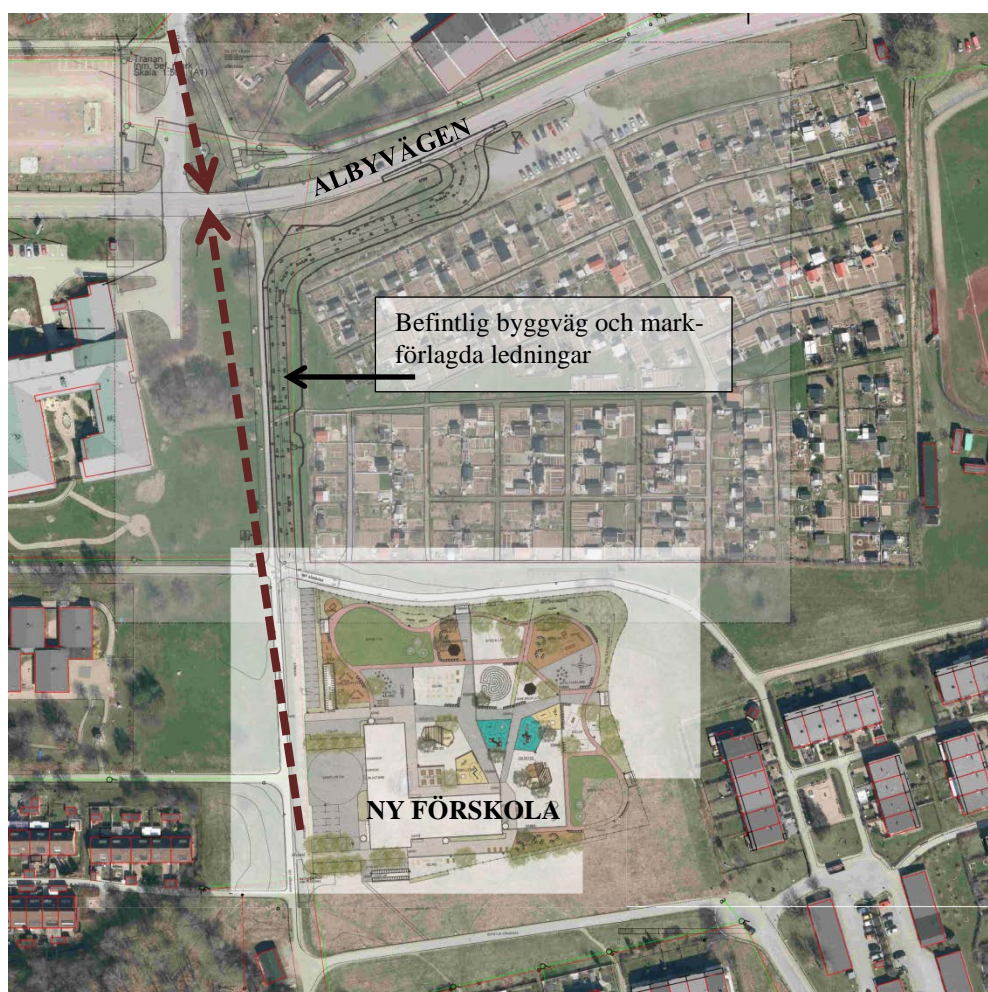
Förskolan, Albyvägen och området norr om Albyvägen kopplas ihop, streckade pilar.
